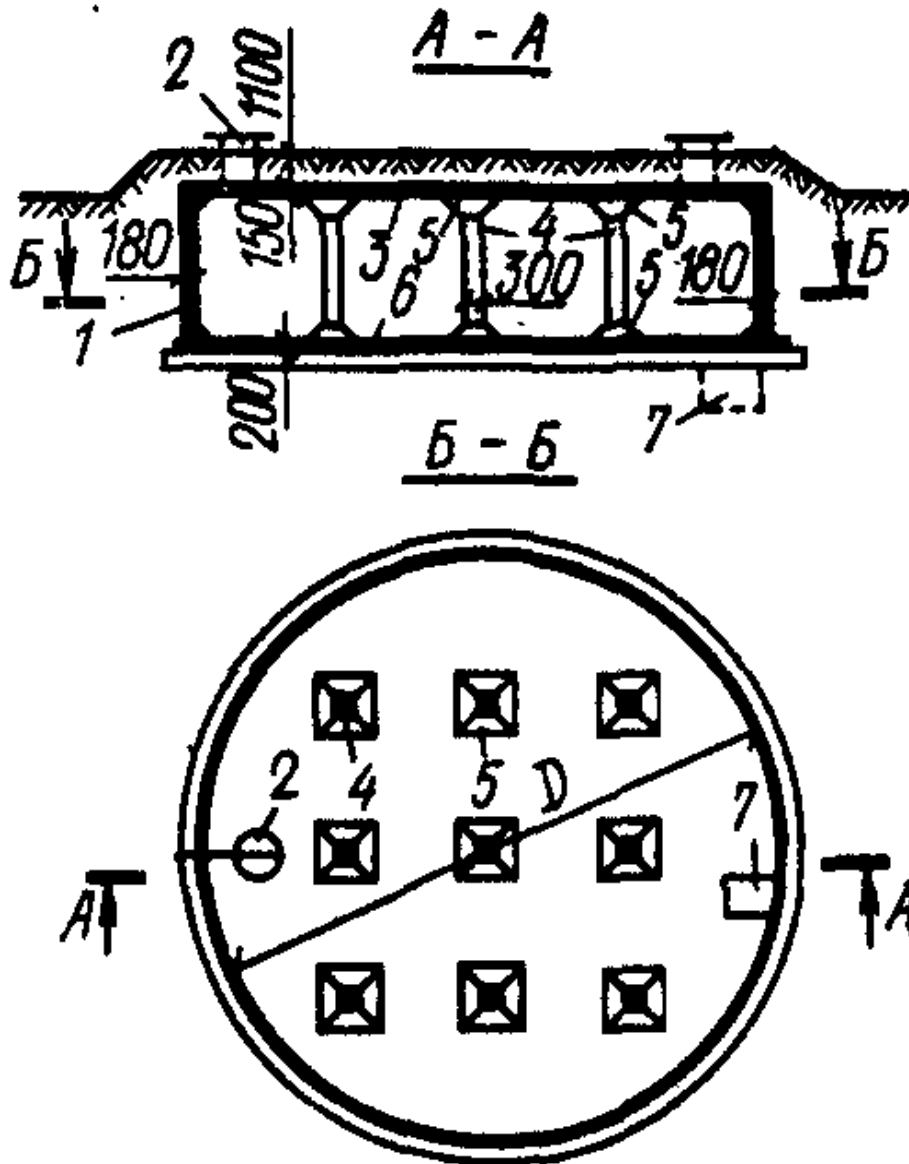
Цилиндрический монолитный резервуар с безбалочным покрытием
